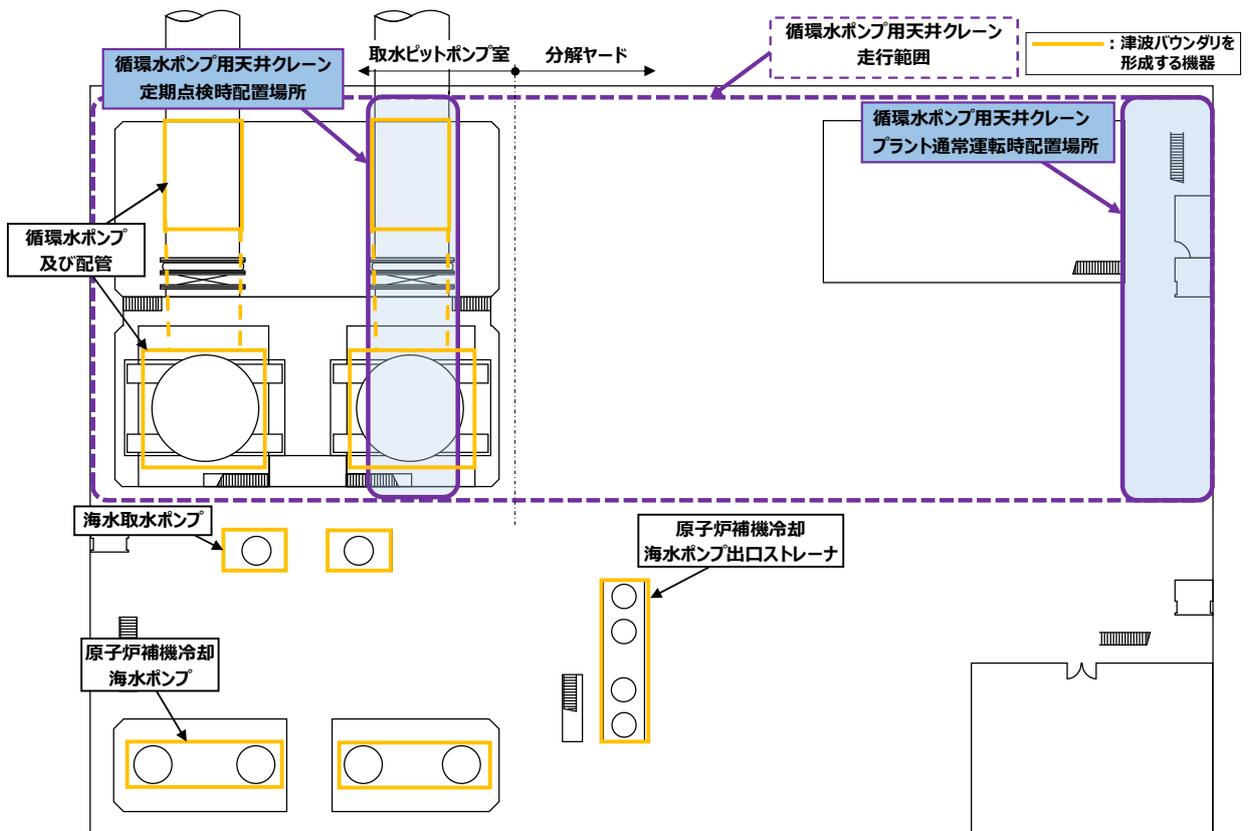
循環水ポンプ用天井クレーン配置図 (循環水ポンプ建屋 平面図※ 地上階 (T.P. 10.3m))
